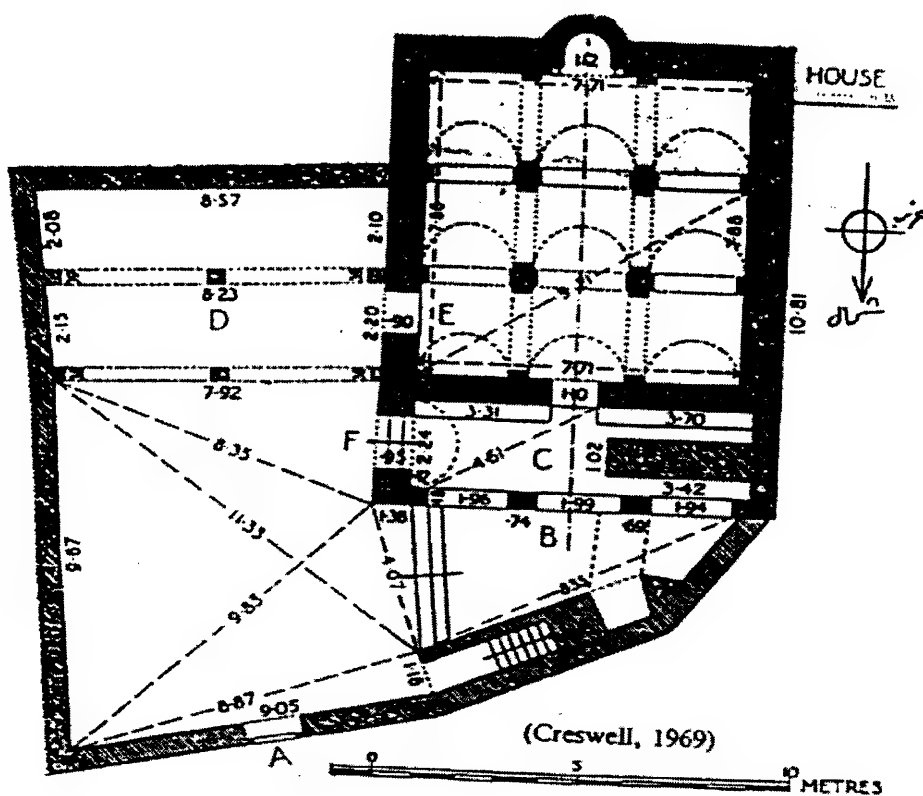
المسقط الأفقي لمسجد أم الوليد .
